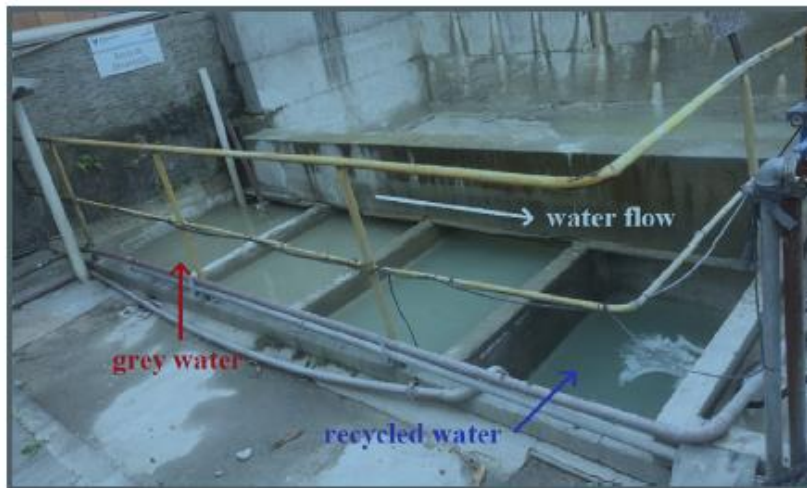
Poso de sedimentación de una planta de hormigón.
